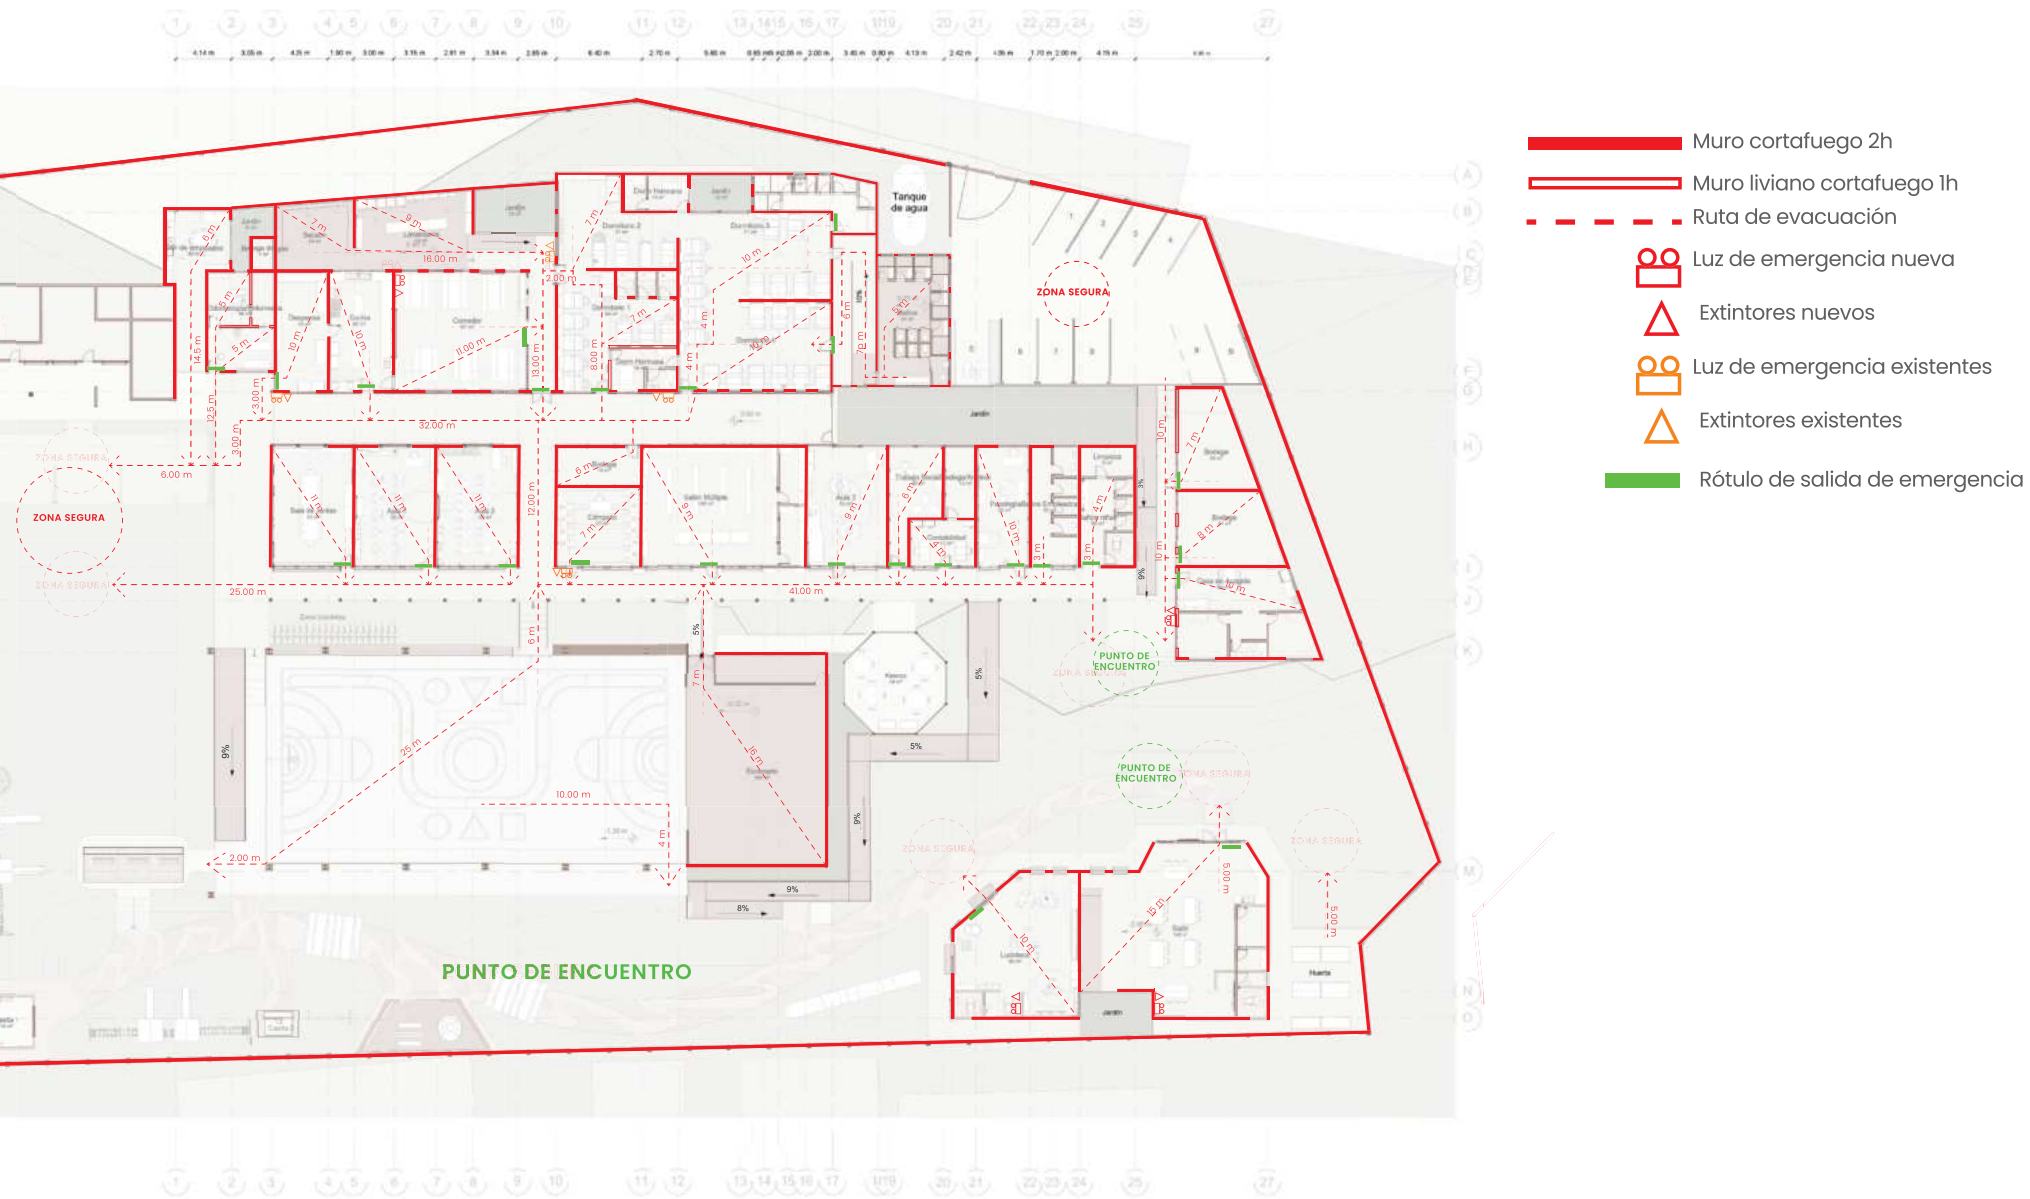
Planta de Seguridad humana | Fuente: Elaboración propia
